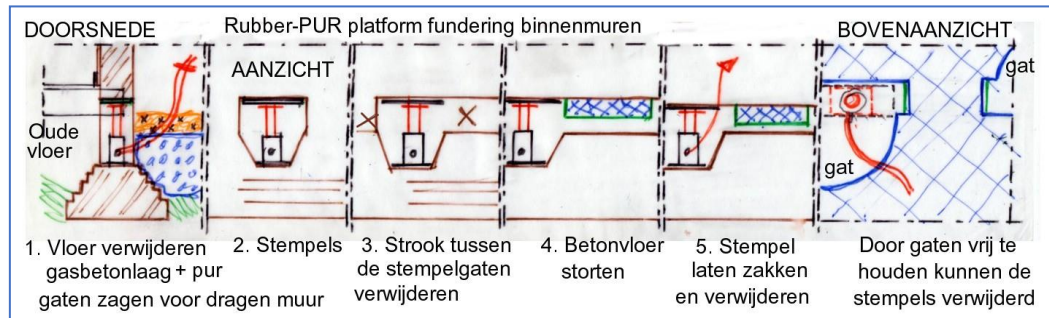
Stappenplan voor het storten en naar beneden vijzelen.
